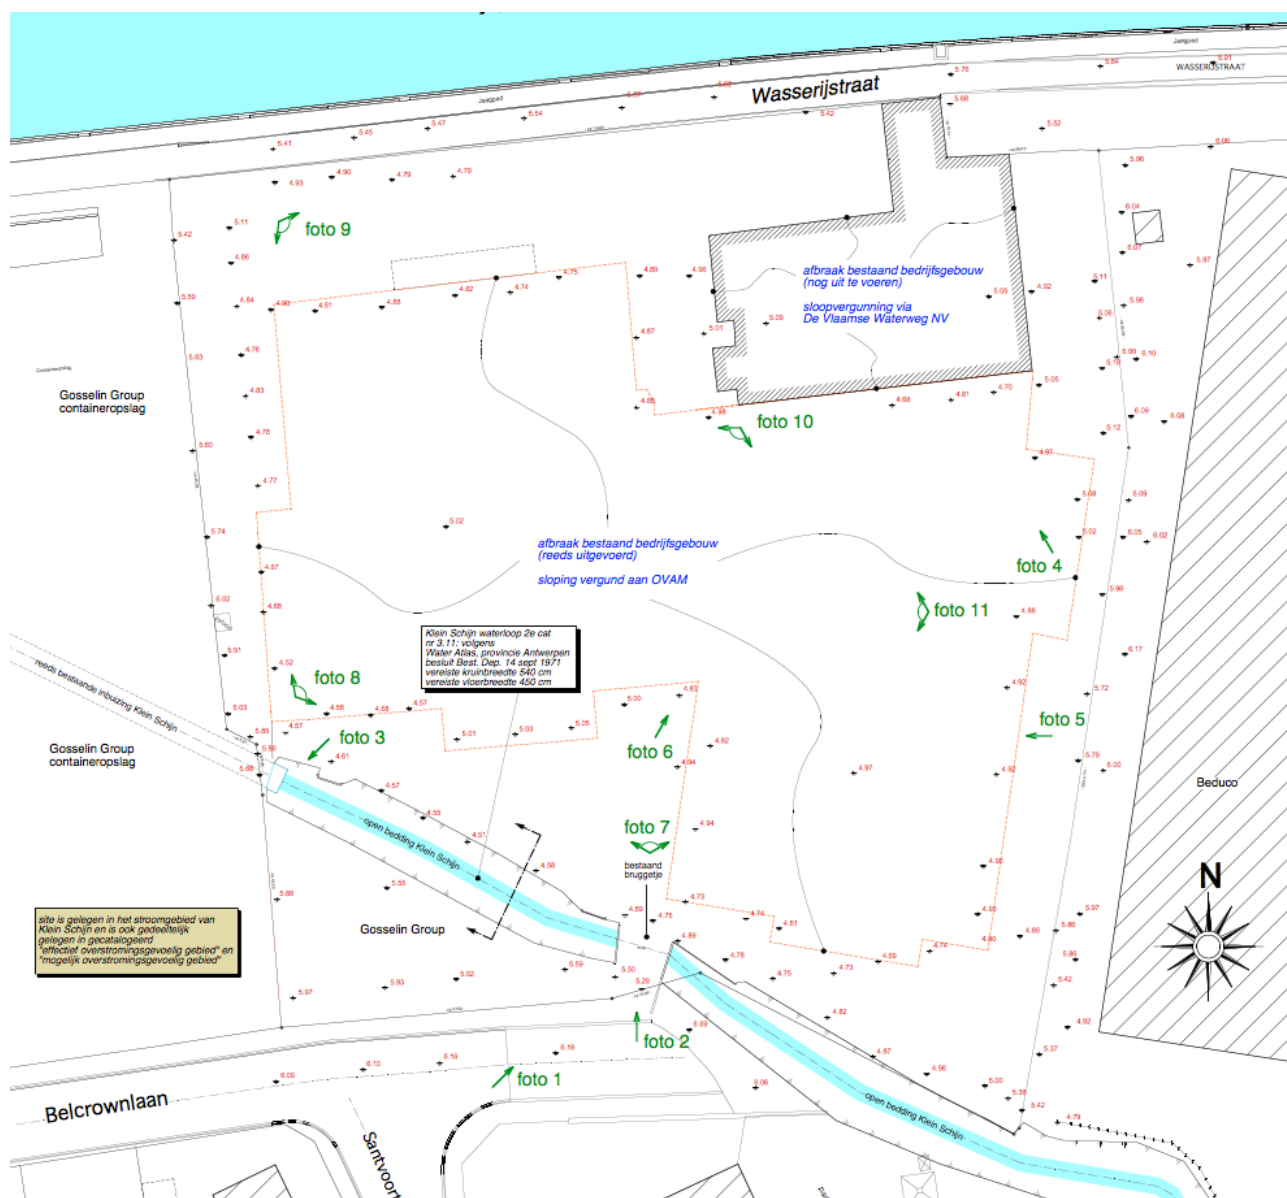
PLAN 3 Bestaande toestand. © STYLUS architecten
